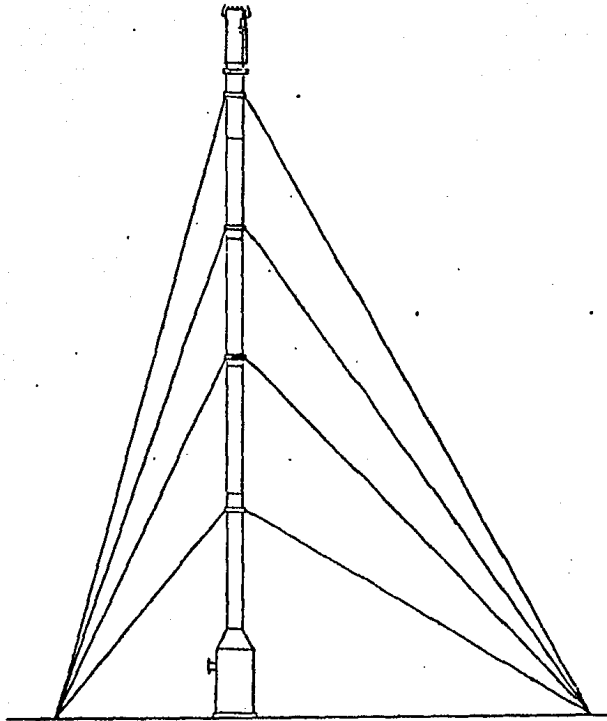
QUEMADOR ELEVADO CABLEADO
